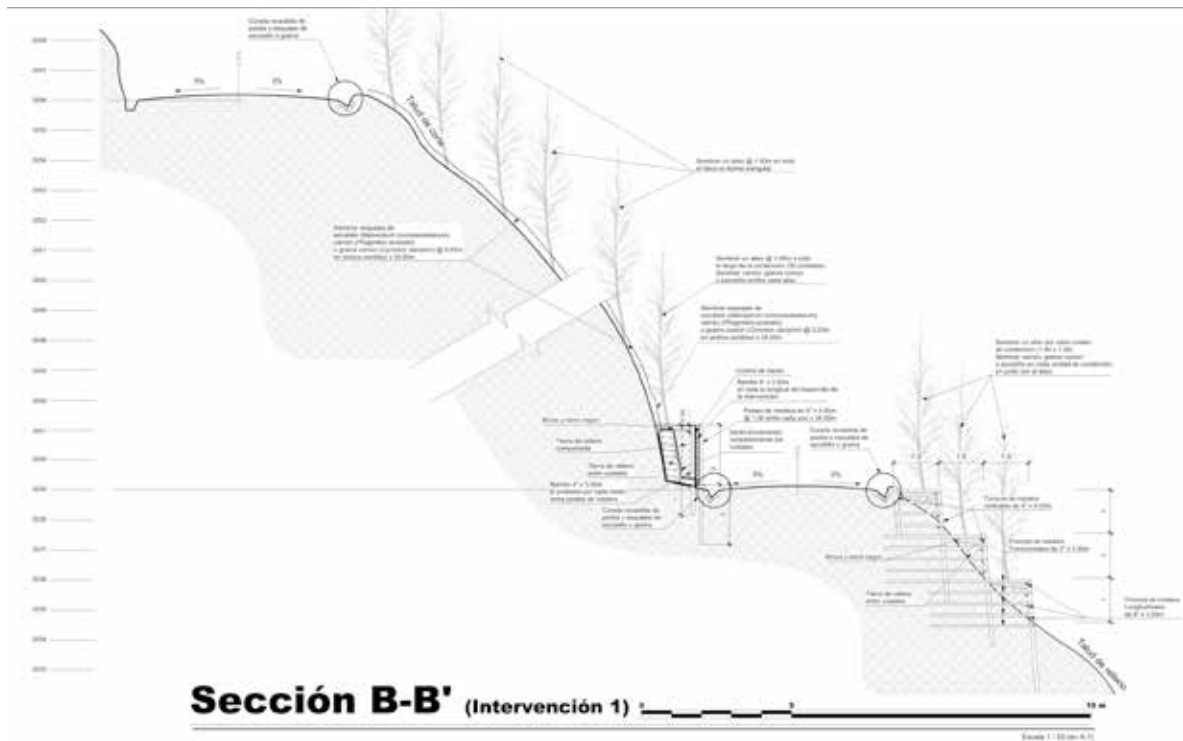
Sección B-B'. Planificación Obra ORCC-02/RD-SOL-08.
